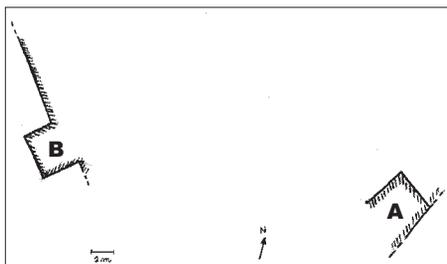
Schizzo planimetrico indicante la posizione della torre principale (A) e della torre di guardia (B). Un rilievo planimetrico più accurato dell'intero circuito murario sarà pubblicato prossimamente.
